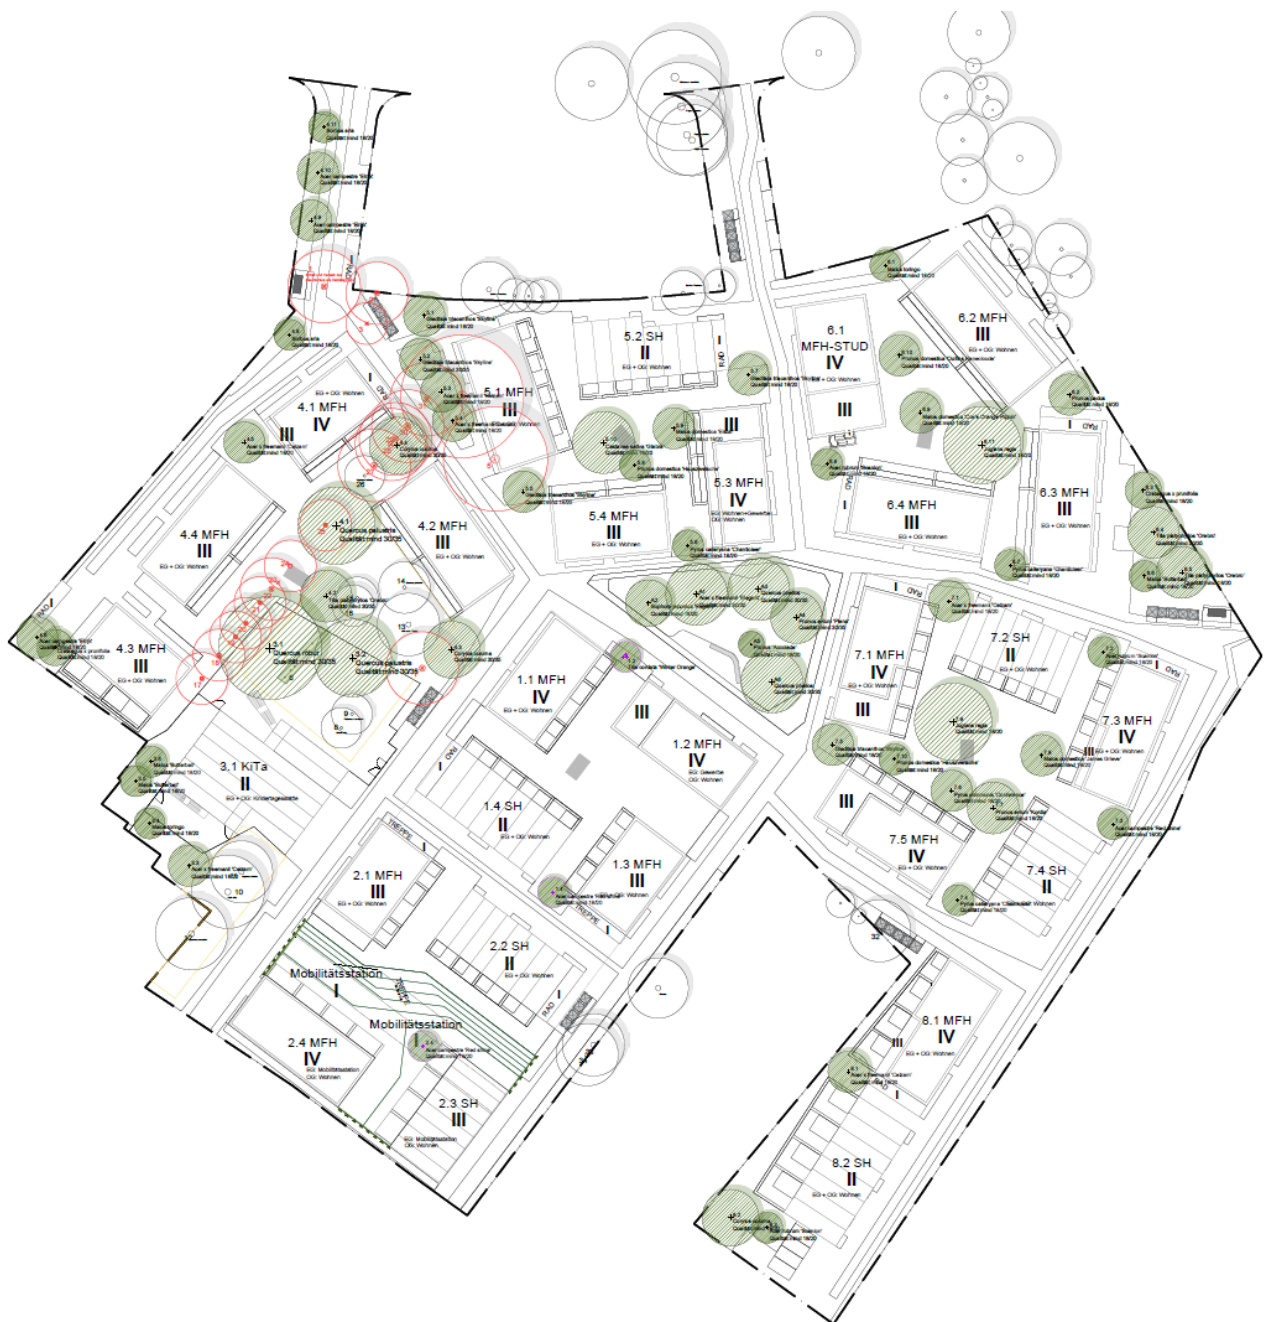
Baumbilanzplan (Auszug ohne Pflanzliste; rot: entfallende Bäume; grün: Neupflanzungen)
